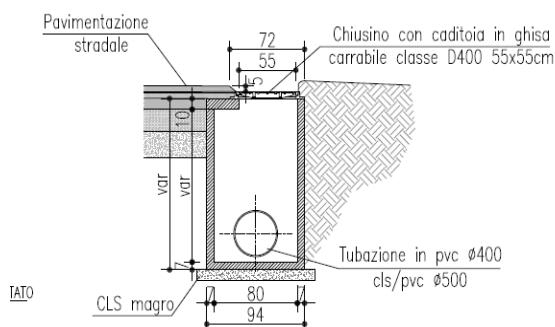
Pozzetto caditoia in cunetta rettangolare.
